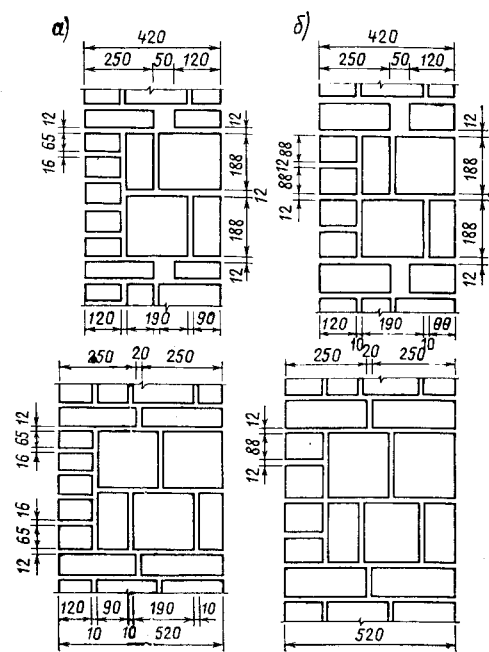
Типы кладок стен из мелких ячеистобетонных блоков с наружной облицовкой в 1/2 полнотелого кирпича, выполненной на гибких металлических связях
